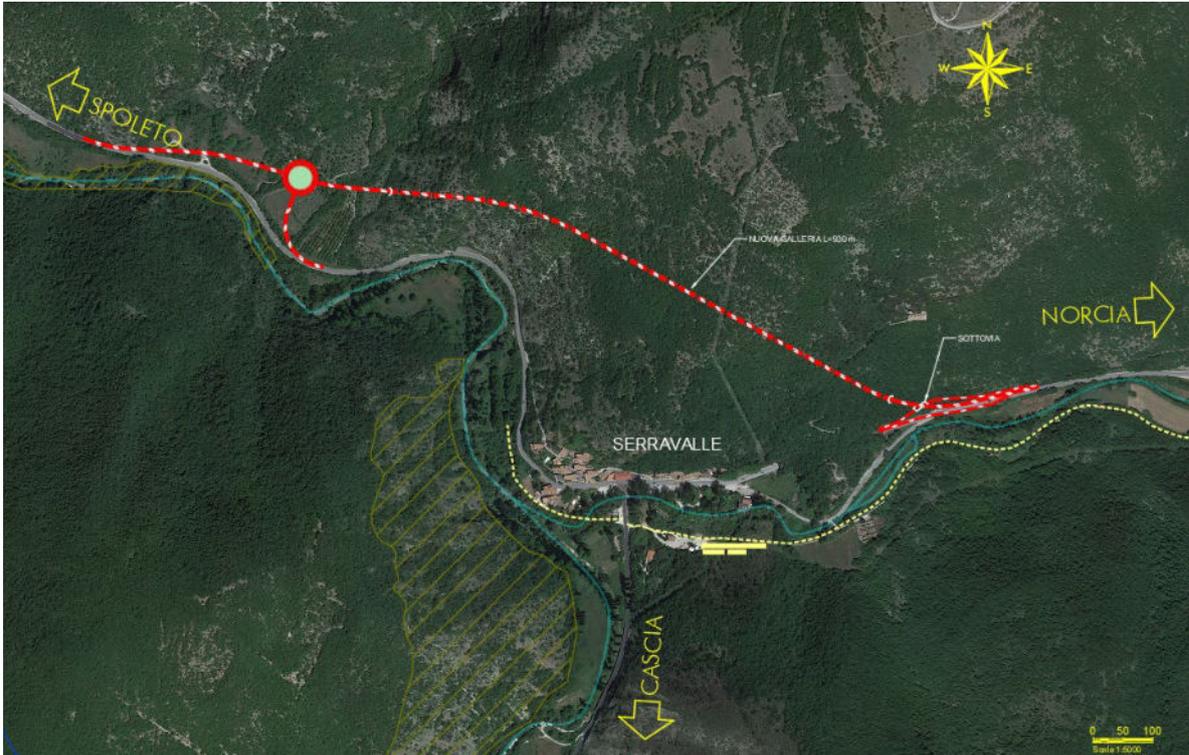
Planimetria di progetto Alternativa2- galleria
